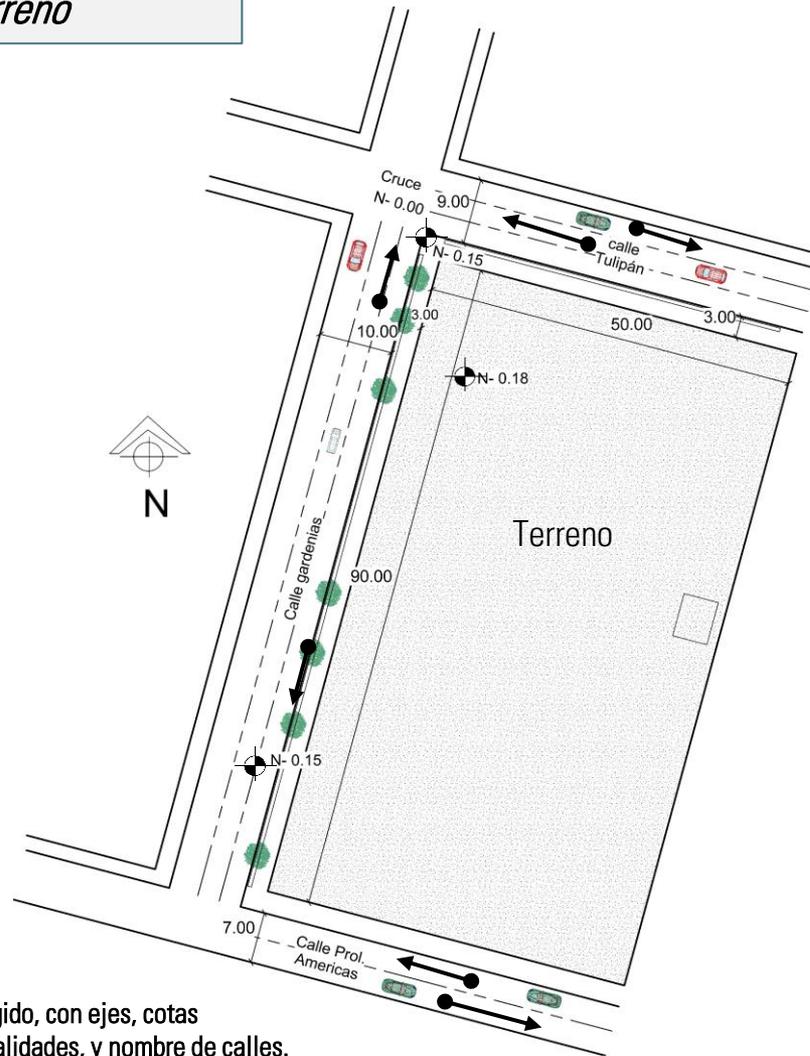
Levantamiento de terreno elegido, con ejes, cotas
